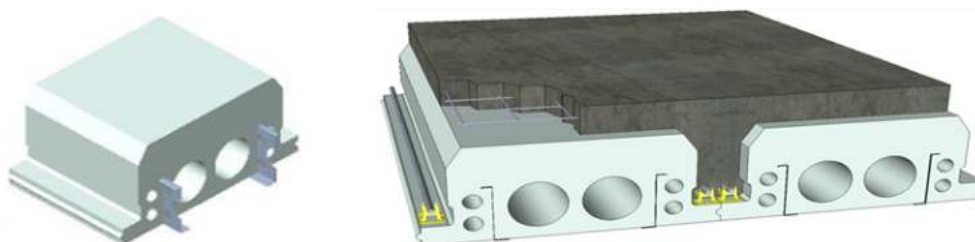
a) Elementy využívané pri technológii U-Boot Beton b) Stropný systém U-Boot Beton
